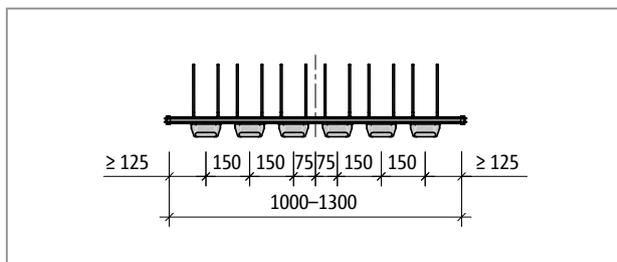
Schöck Tronsole® Typ T-V6-...-L1000 bis L1300: Produktgrundriss
